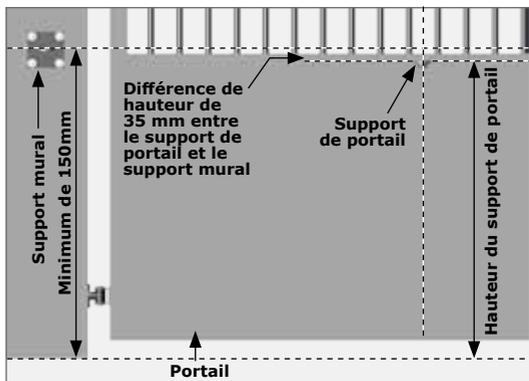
HAUTEUR DU SUPPORT MURAL
